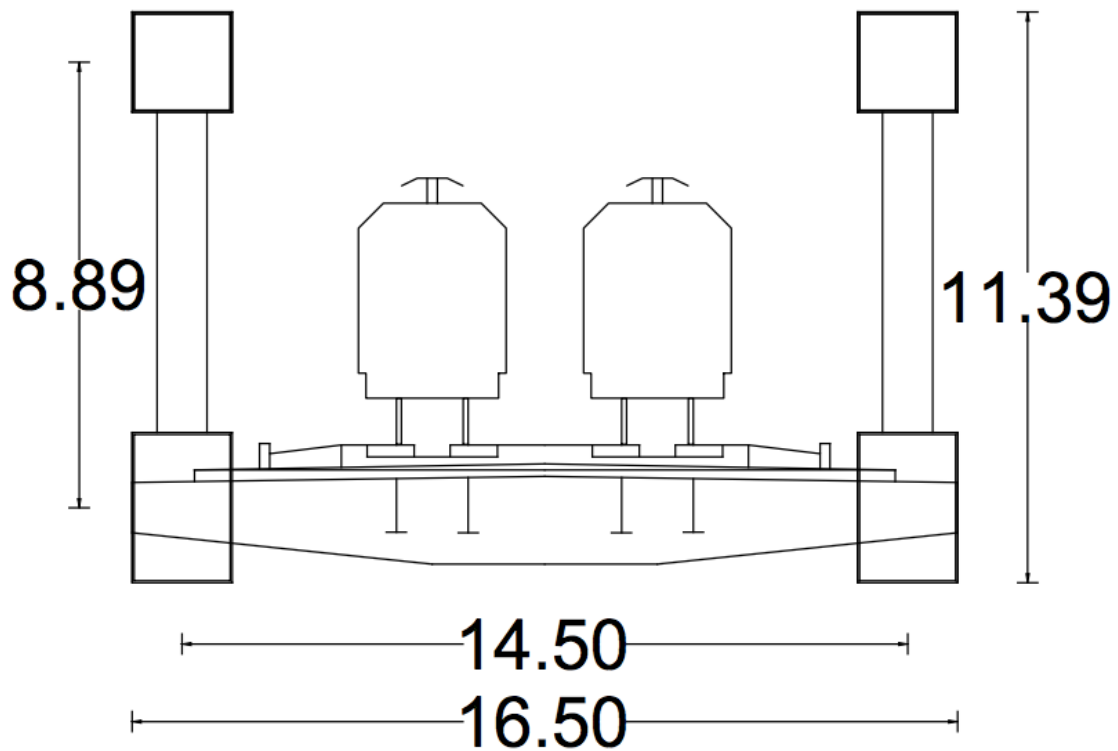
Sección del tablero en el diseño inicial del puente.
